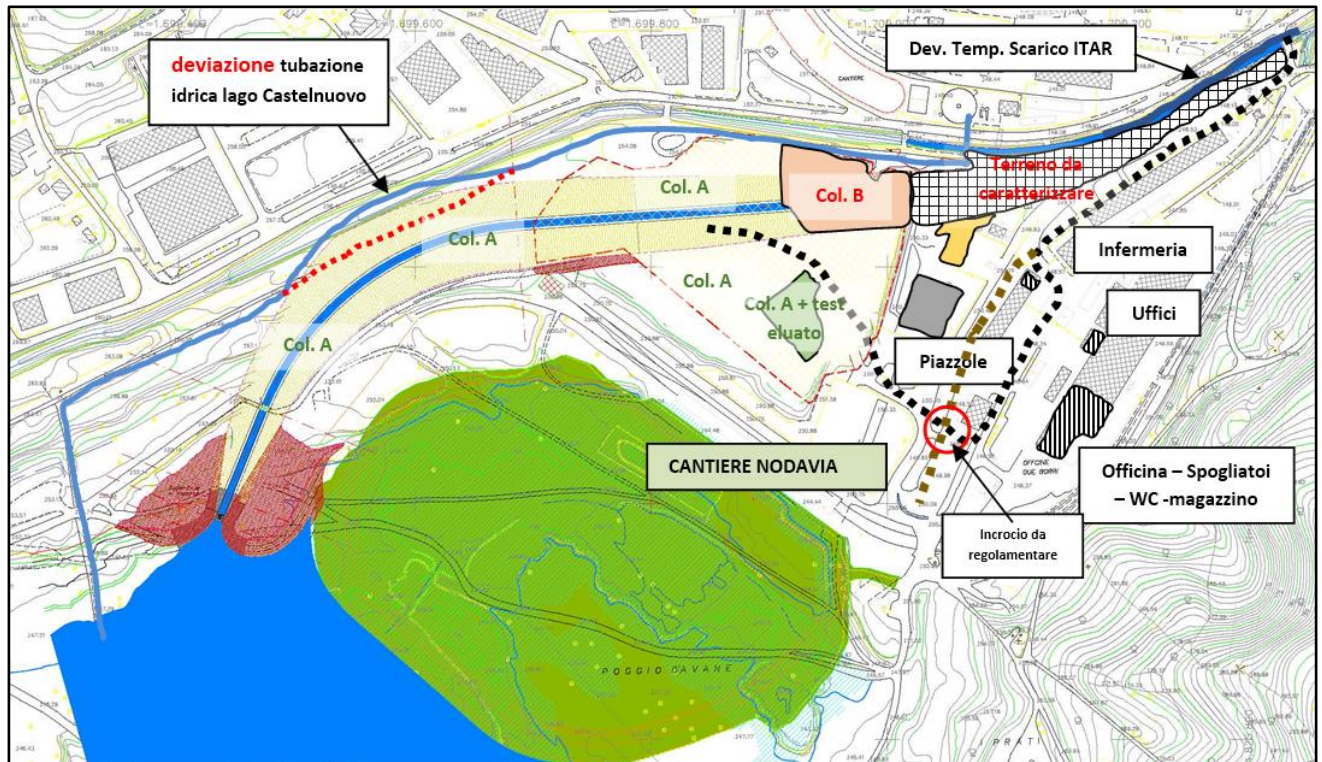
FASE 1: ALLESTIMENTO CANTIERE
